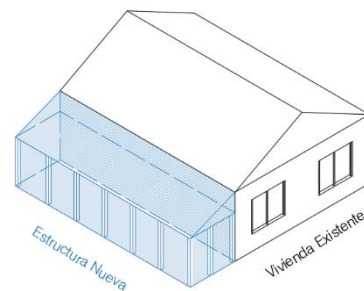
Estructura nueva y vivienda existente. Fuente: Elaboración Propia.
